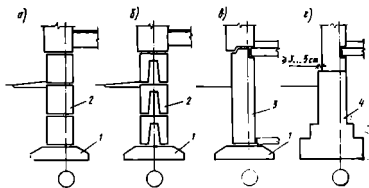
Конструкции столбчатых фундаментов для каркасно-панельных гражданских зданий:
